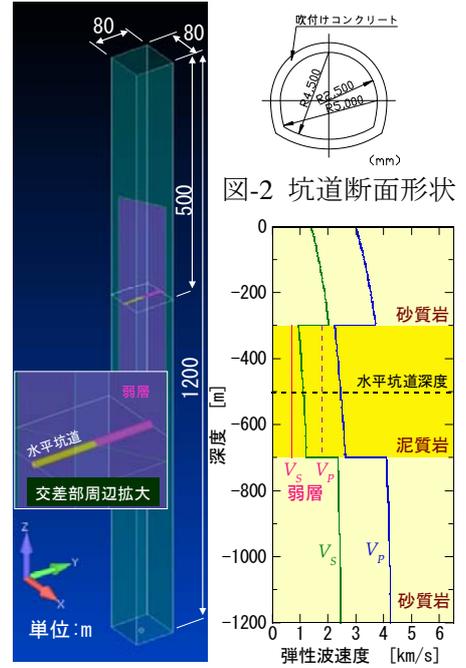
検討対象 図-2 坑道断面形状 図-3 地盤モデル
